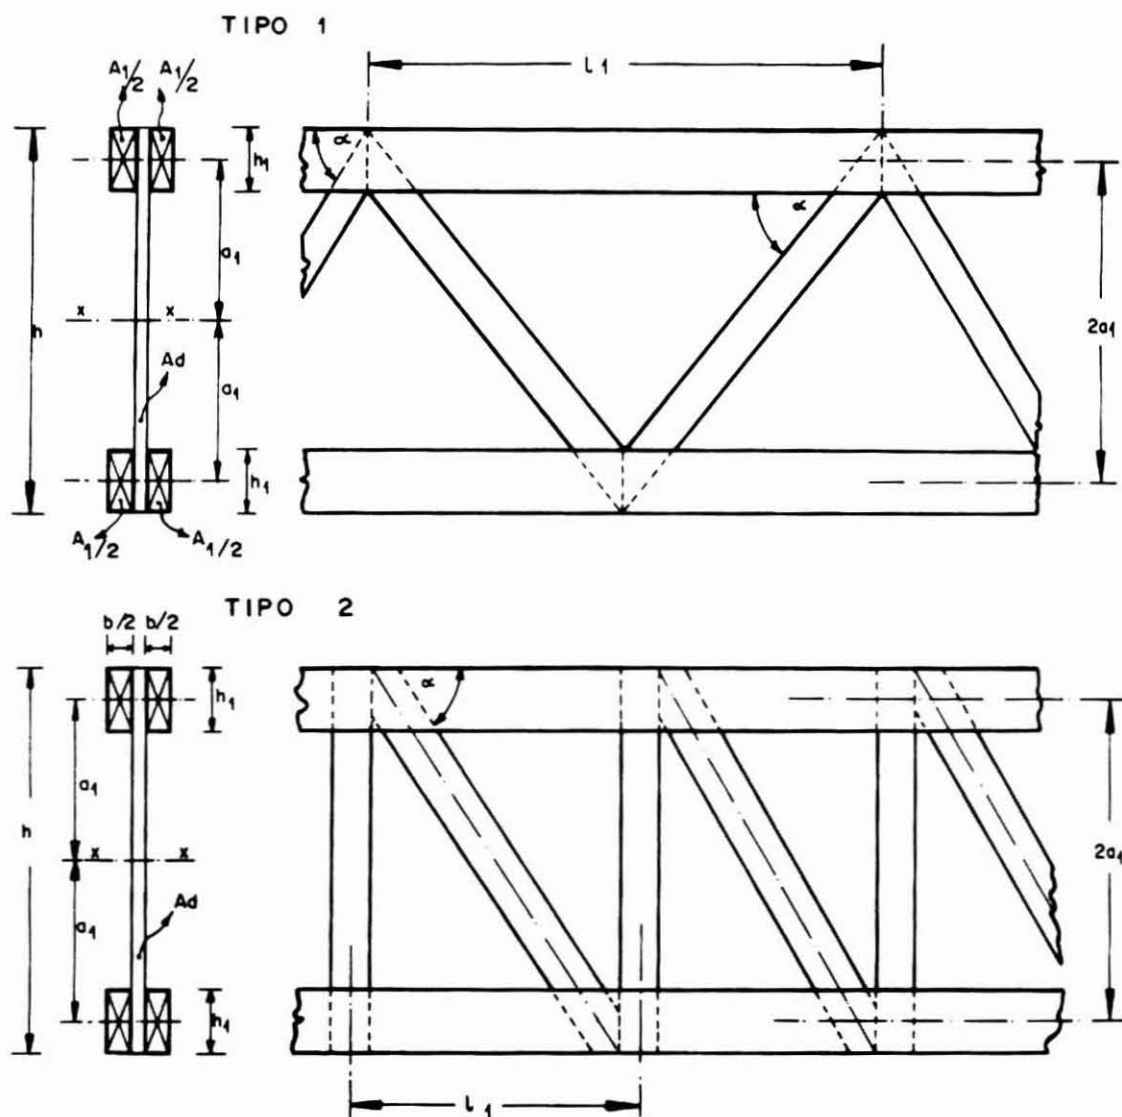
Vigas enrejadas con cordones paralelos.
